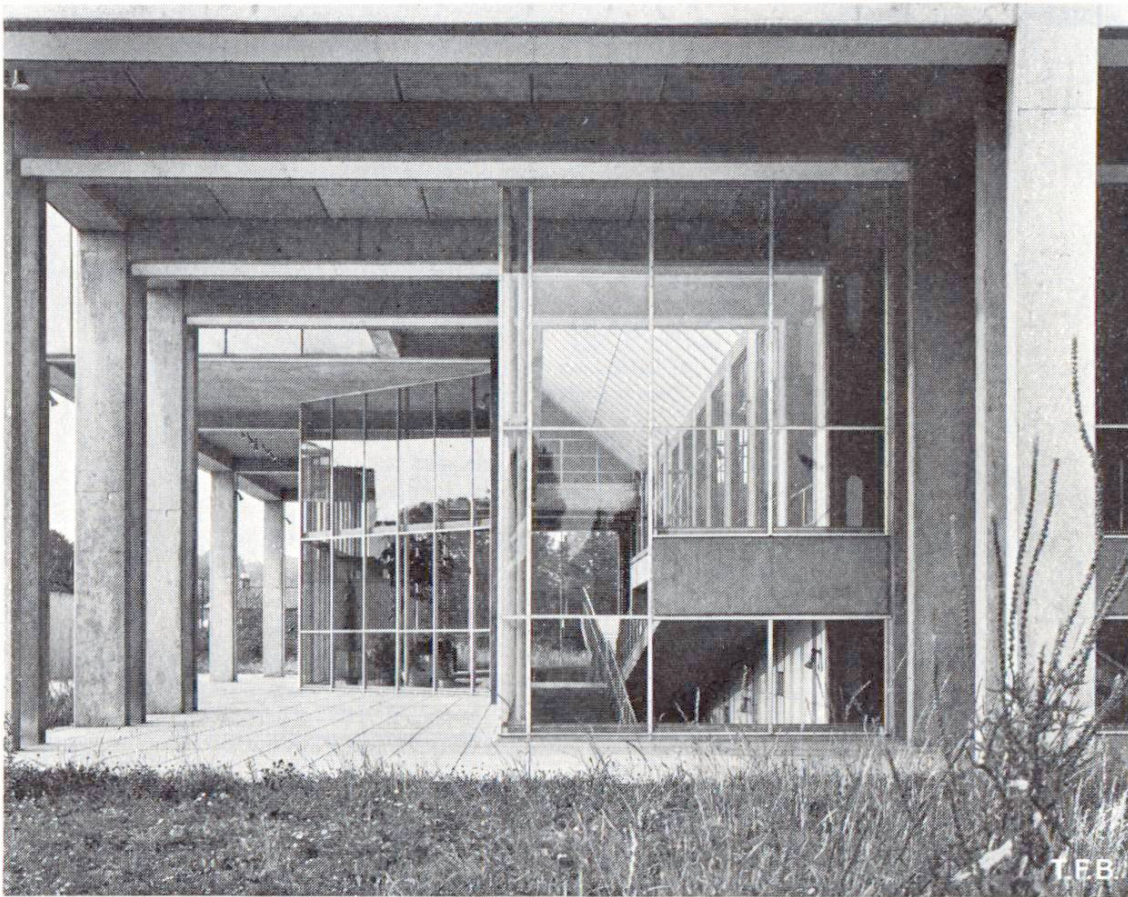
La halle d'entrée vue de côté. Les piliers doubles et les poutres ont tous les mêmes dimensions et sont placés à intervalles normalisés. Les dalles de revêtement des plafonds et des sols sont préfabriquées.
